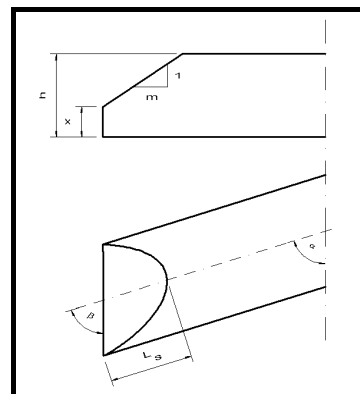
Geometrie am Schrägschnitt in Ansicht und Grundriss
